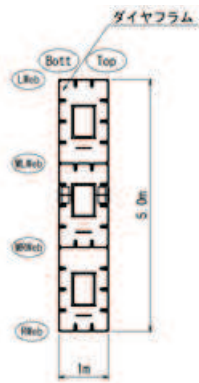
(2) 鋼製遮水壁 (鋼桁 3) 平面図
